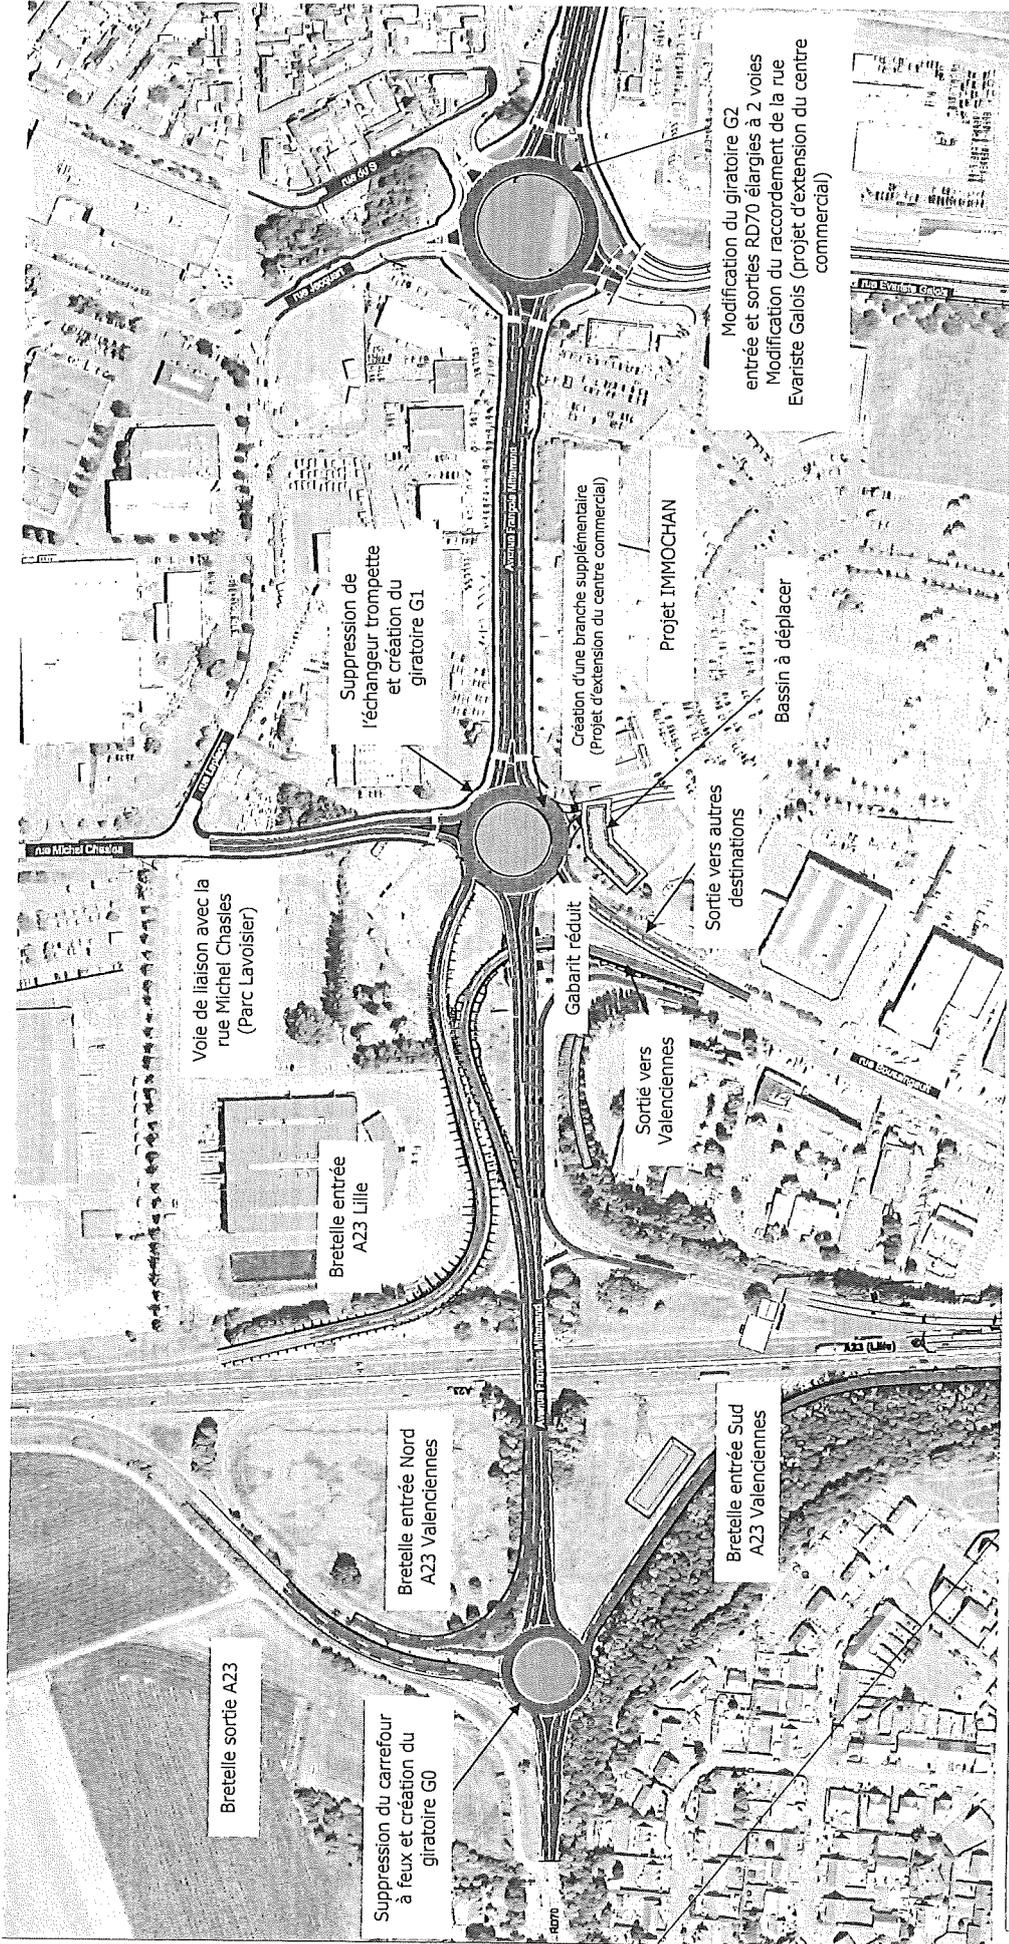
Plan de définition générale de l'aménagement (Section Ouest)
